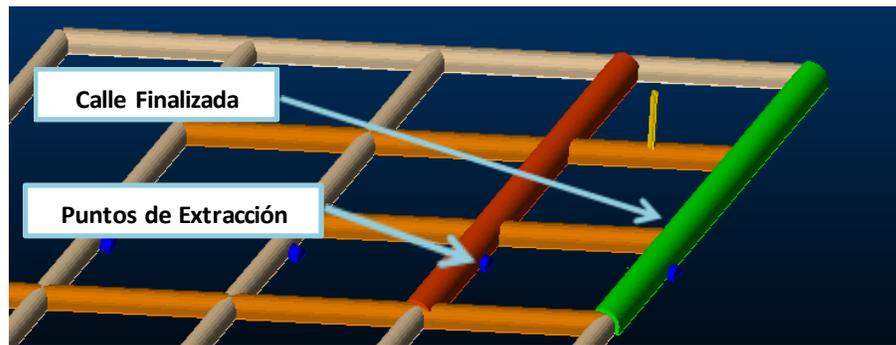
Criterios de Constructibilidad, Chimeneas Piloto
